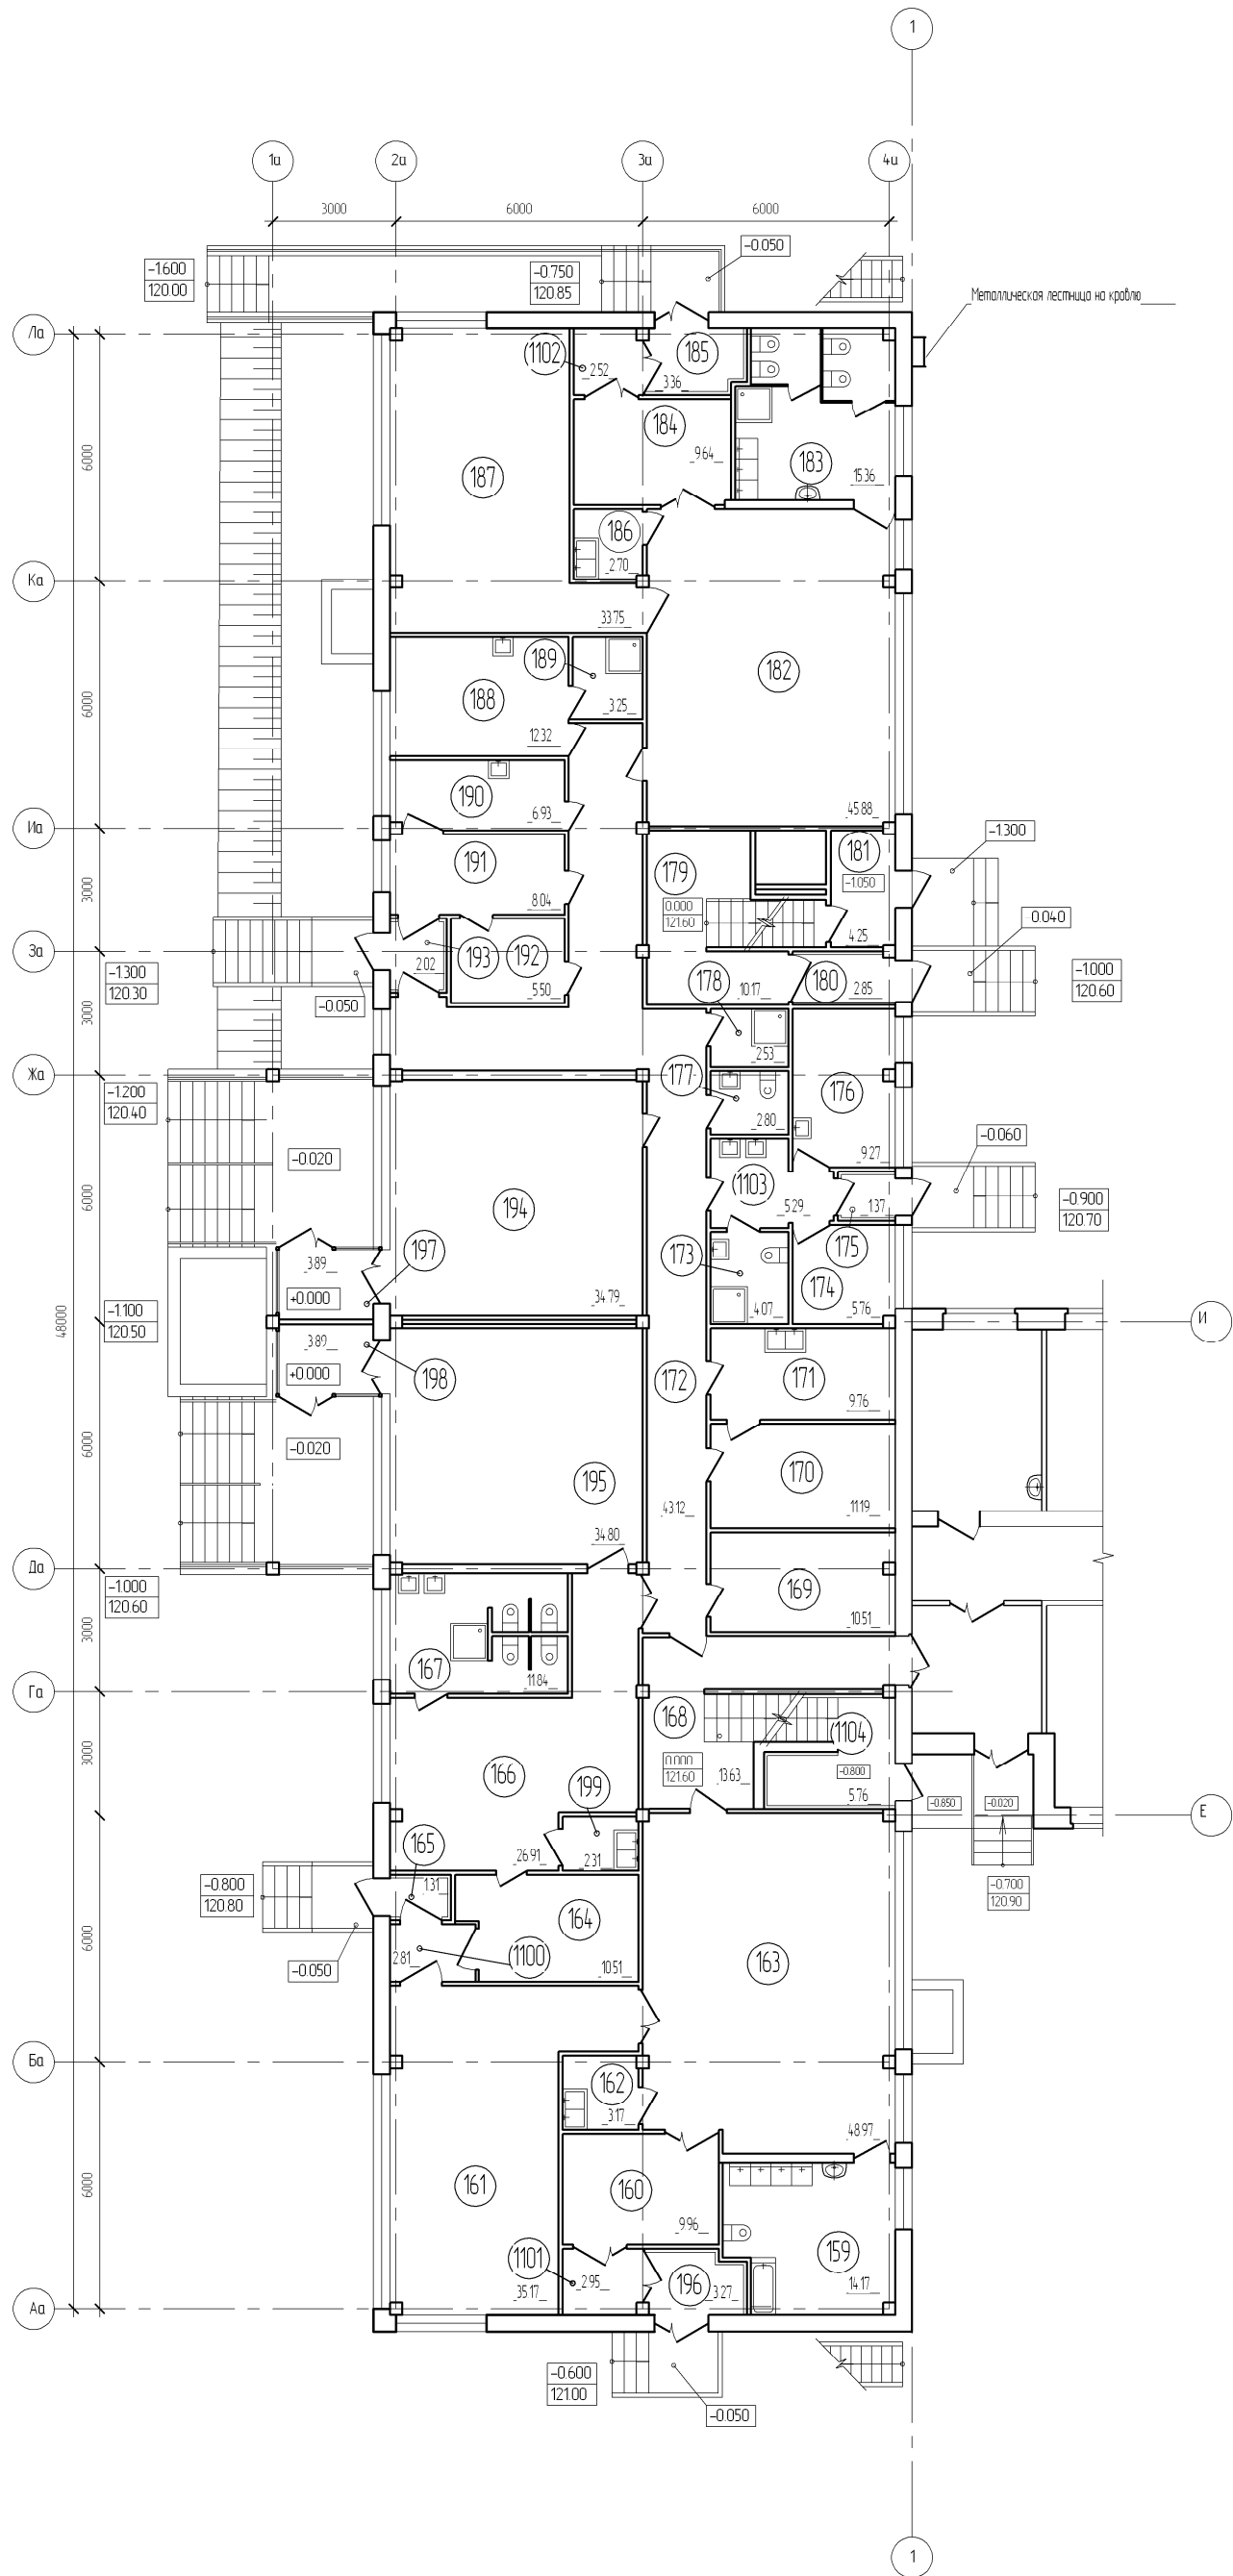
План 1-го этажа здания Детского сада на 60 мест с начальной школой на 100 учащихся
